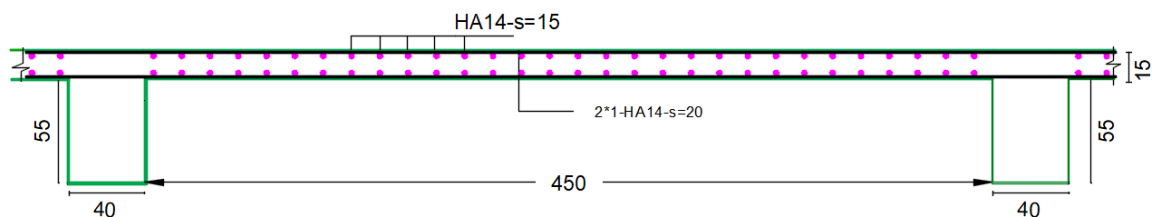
Ferrailage de la dalle (Coupe B-B).
